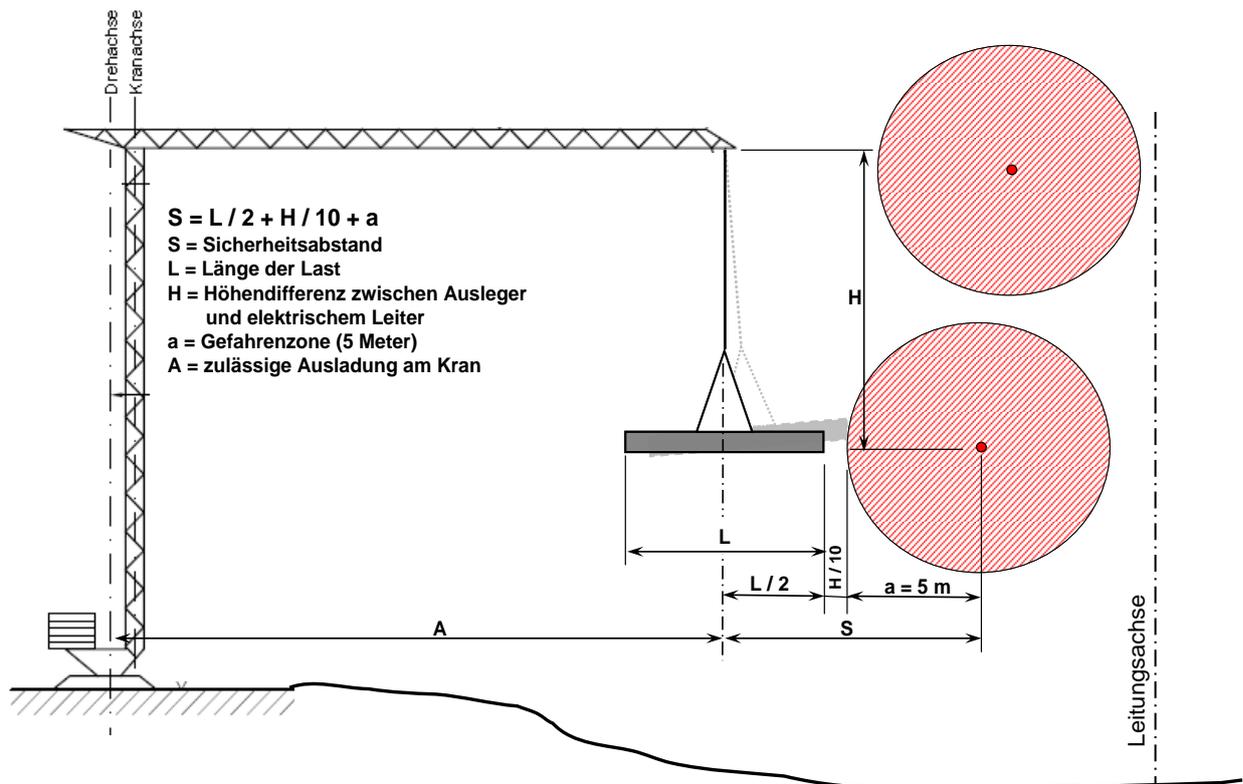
Esempio di rispetto della distanza di sicurezza con gru installata in prossimità di linee aeree FFS
